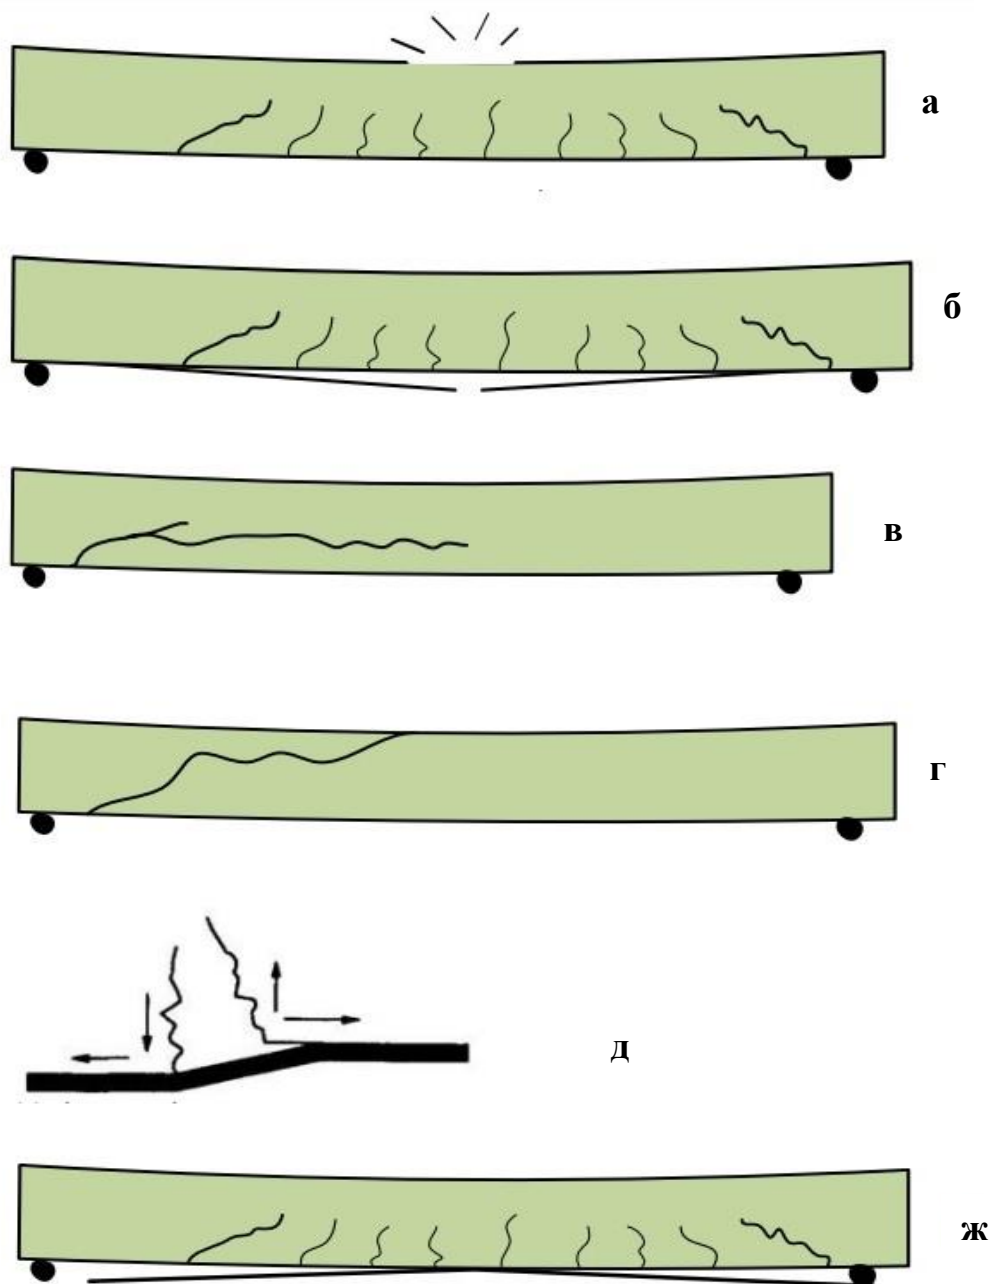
Отказ Modea в FRP модернизированных бетонных балок: (а) отказ, вызванный сжатия бетона; (б) разрушение, вызванное разрывом стеклопластика и текучестью стали; (в) отслоение слоя вдоль арматуры; (г) разрушение, вызванное сдвигом; (д) явная трещина, вызванная пилингом; (ж) расслоение плиты FRP
